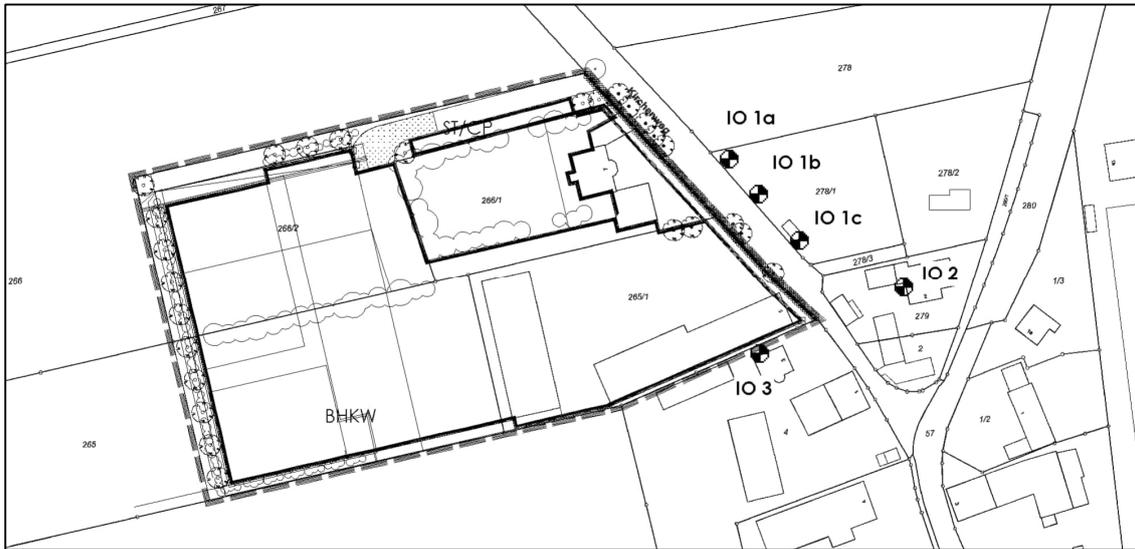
Lageplan mit Darstellung der Immissionsorte (IO)
